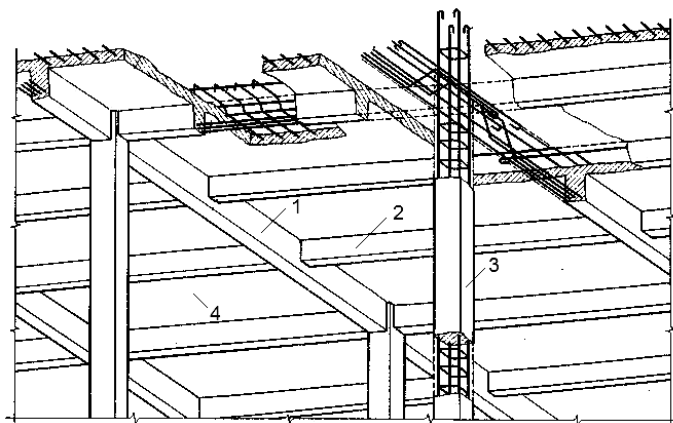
Монолитное ребристое перекрытие с балочными плитами:
